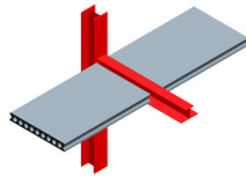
Zulässige Querschnittsformen der Stahlträger
